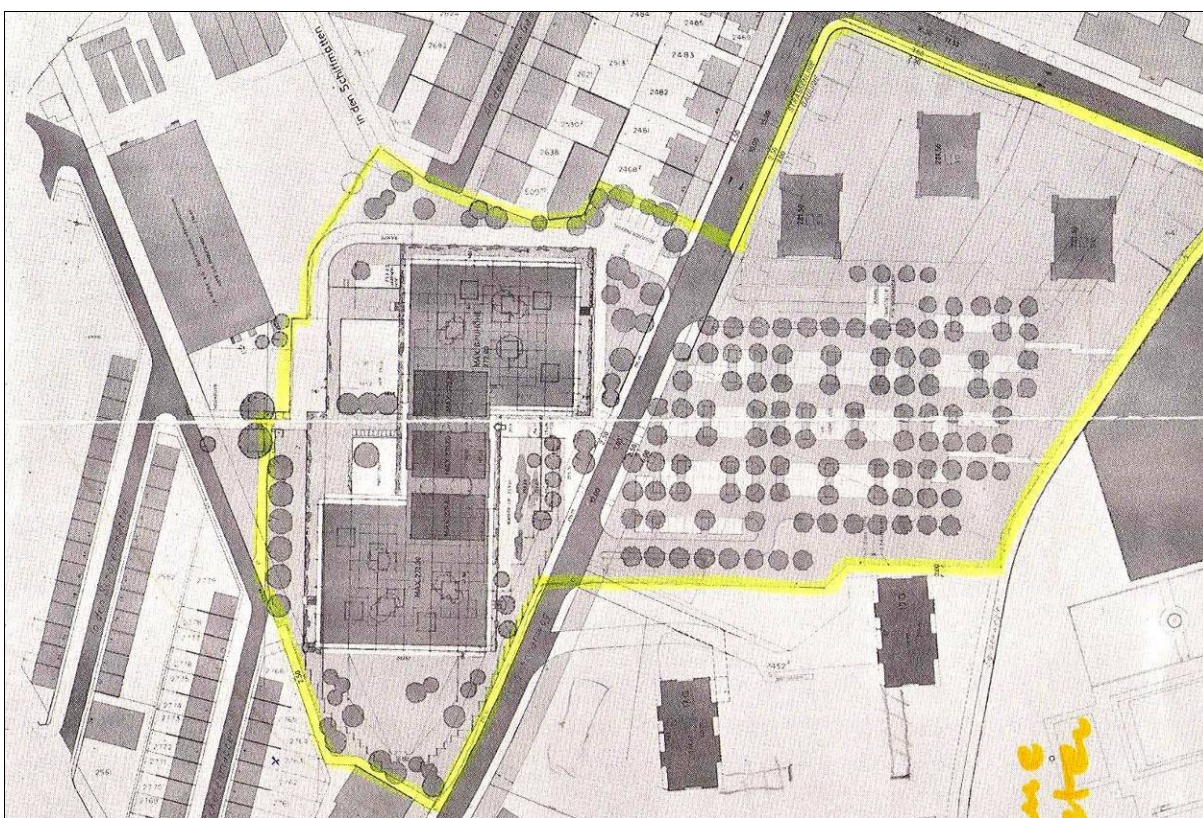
Bestehender Bebauungsplan Areal Schoren. (ohne Massstab, Plan genordet, SBV NR. 106)
